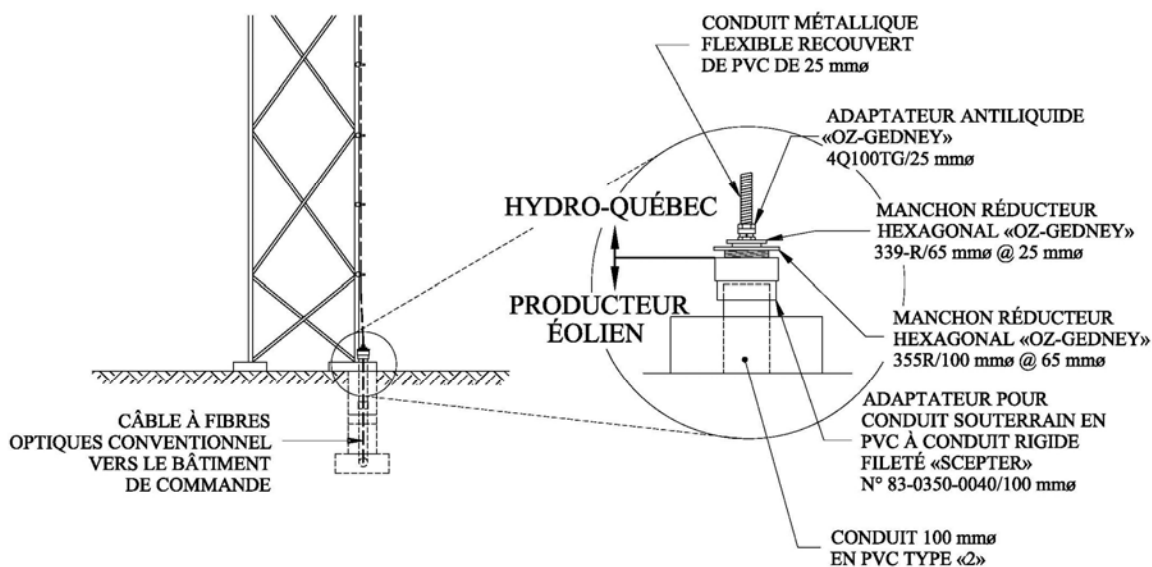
Extrémité du conduit près du point de raccordement (portique ou pylône)
